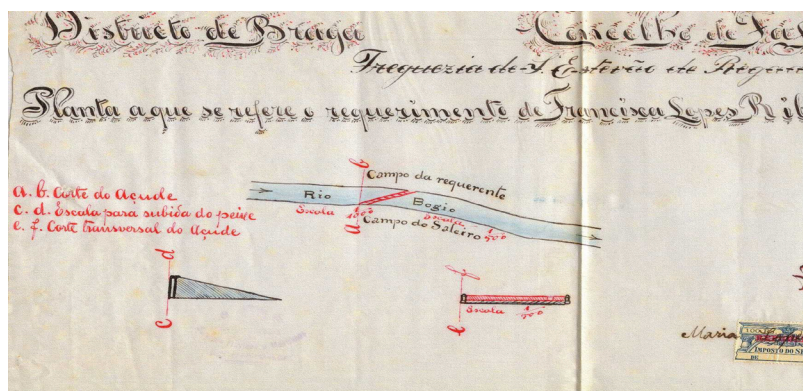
Planta e corte relativos ao processo para construir açude no rio Bugio (Regadas, Fafe, 1912).
